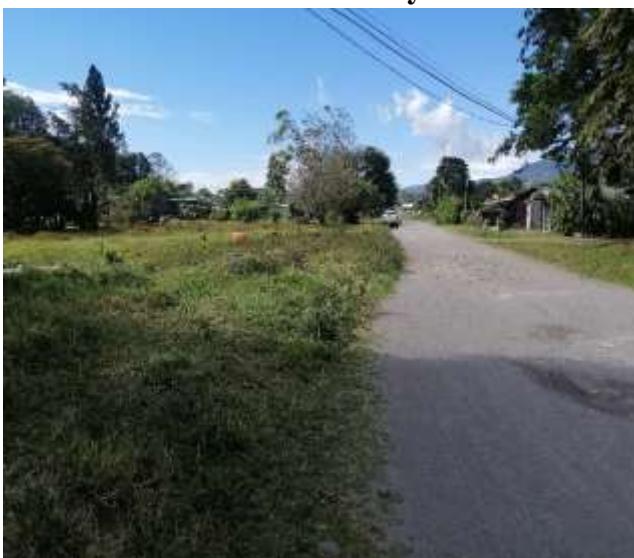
y 4: Vista del área colindante lado norteste y suroeste del proyecto
